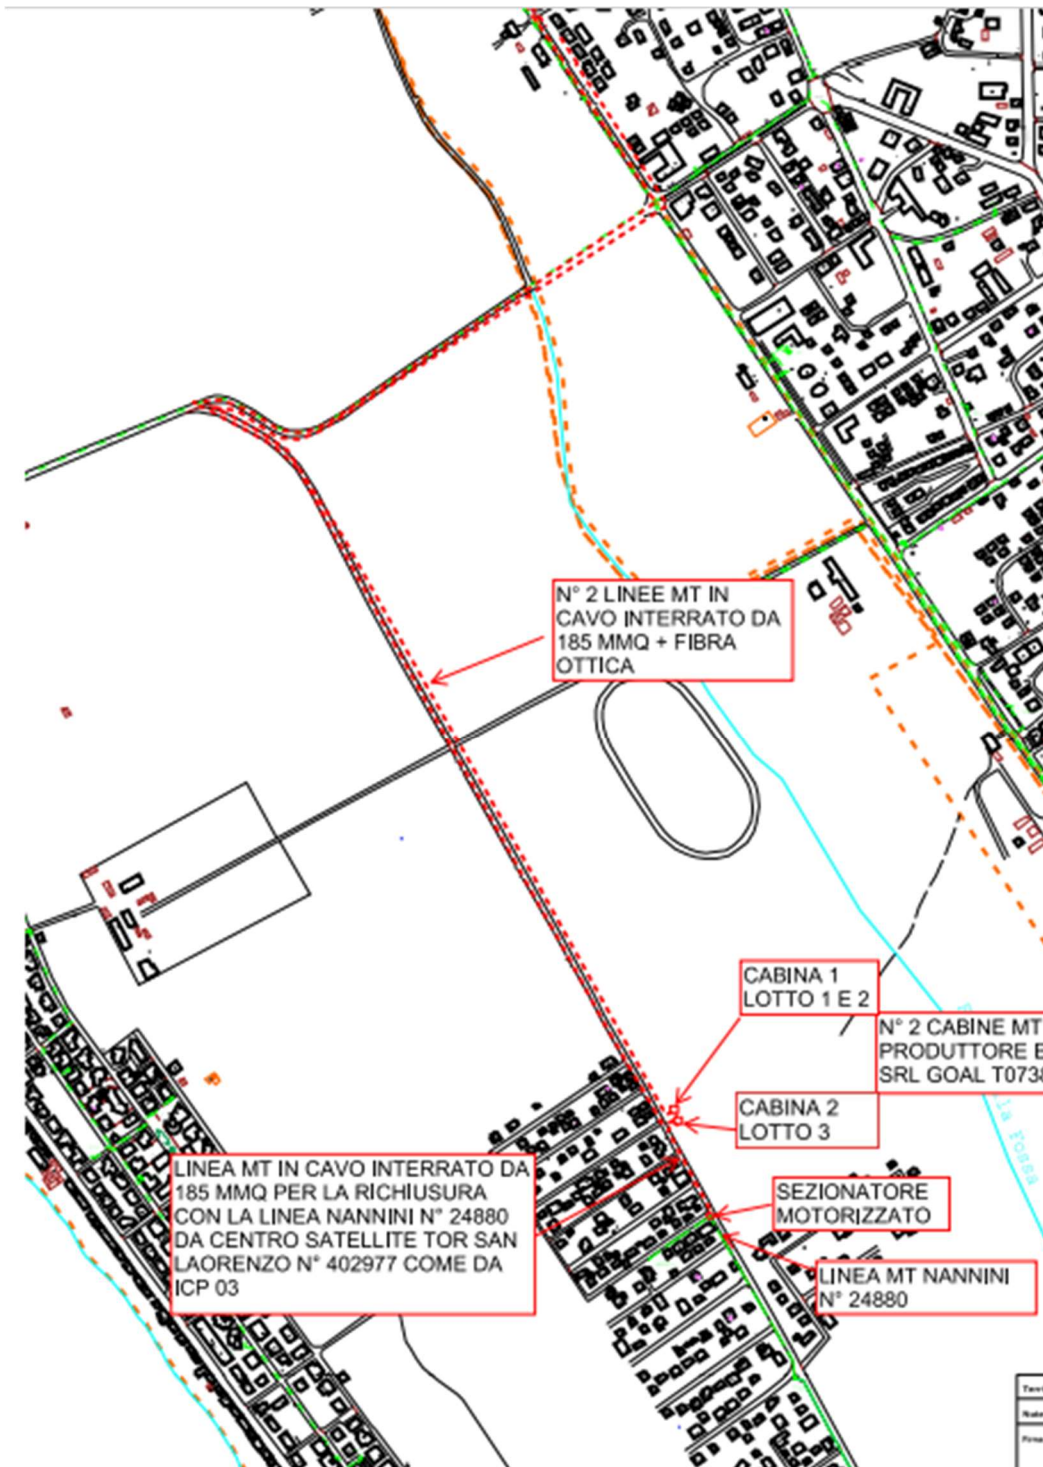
Impianto di rete per la connessione in cavo interrato proposto da e-Distribuzione
